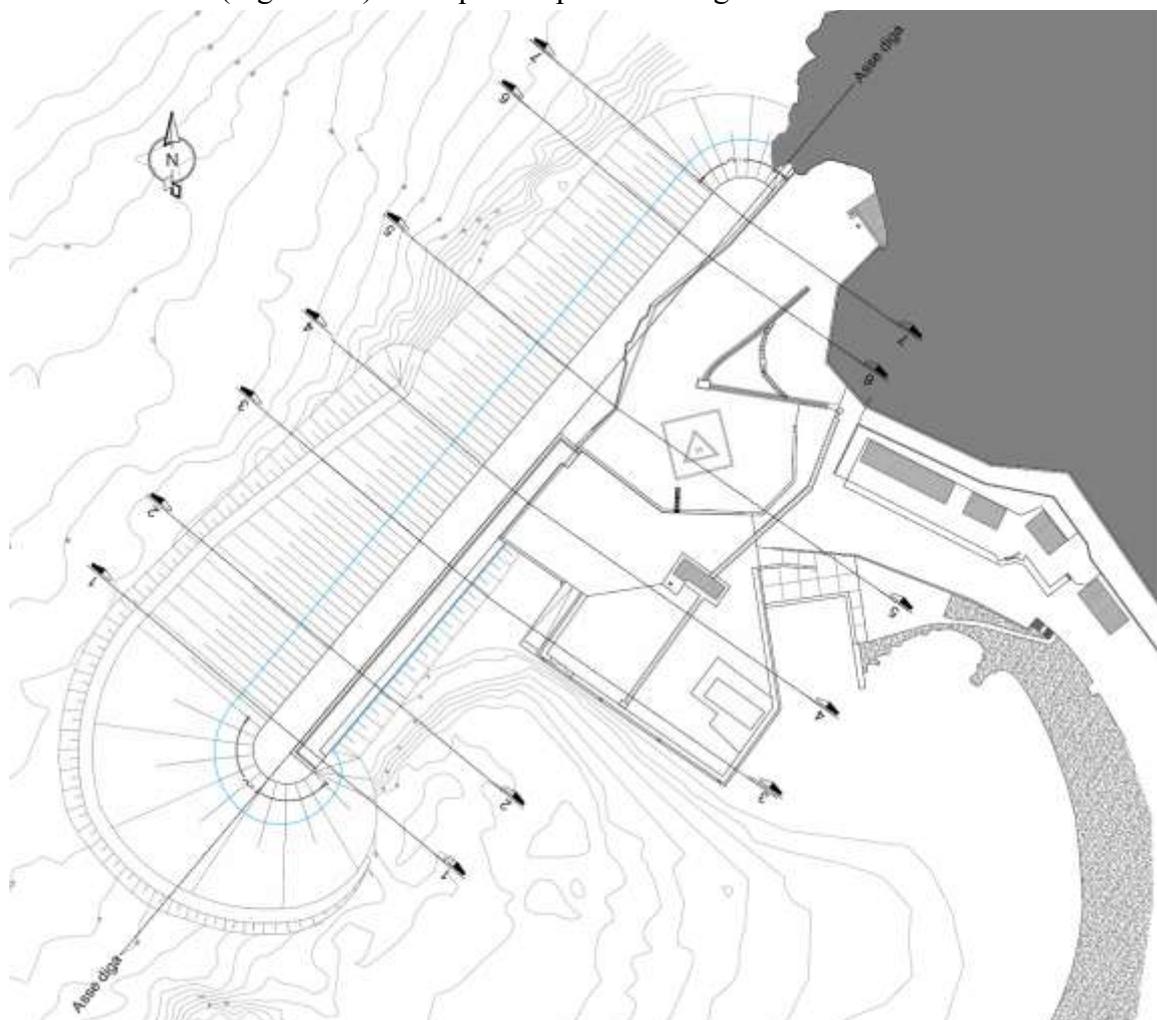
Planimetria di progetto con indicazione dell'ubicazione delle sezioni tipo
